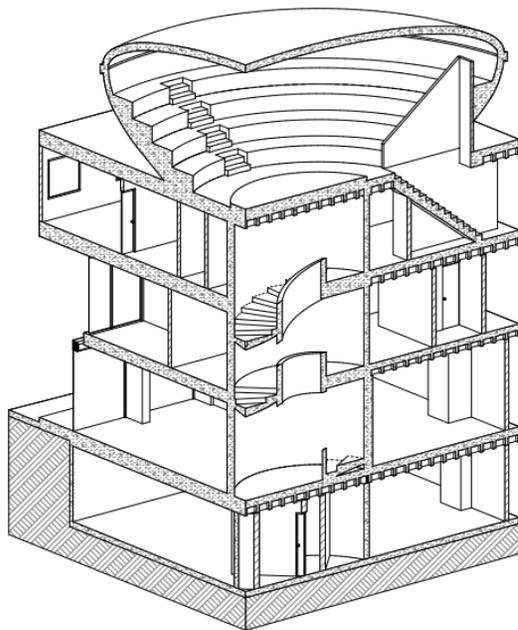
Detalle de sección longitudinal. Fuente: Tesistas.
